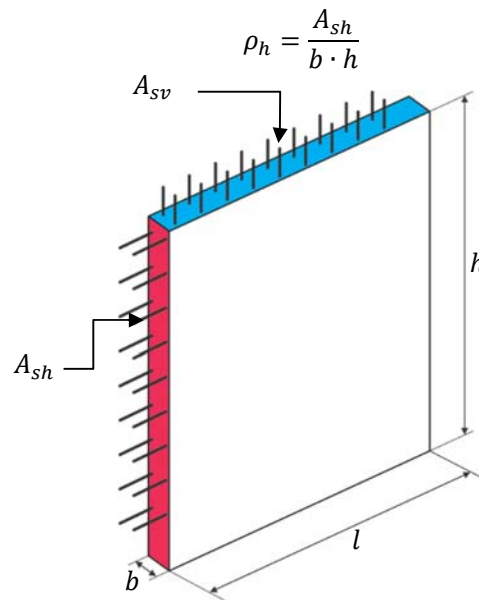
Cuantías de armaduras vertical y horizontal de tabiques
